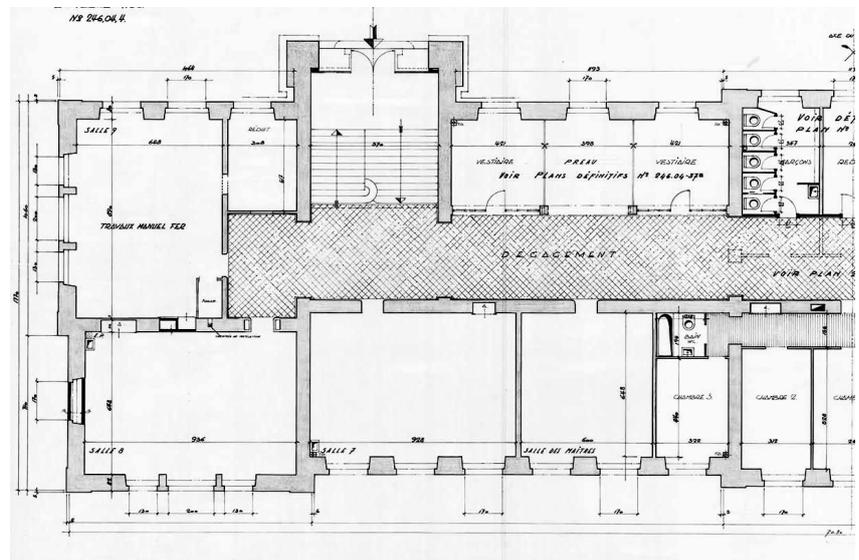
Collège de l'Ouest, plano de renovación, planta sótano. 1960. Service d'urbanisme et de l'environnement de La Chaux-de-Fonds
